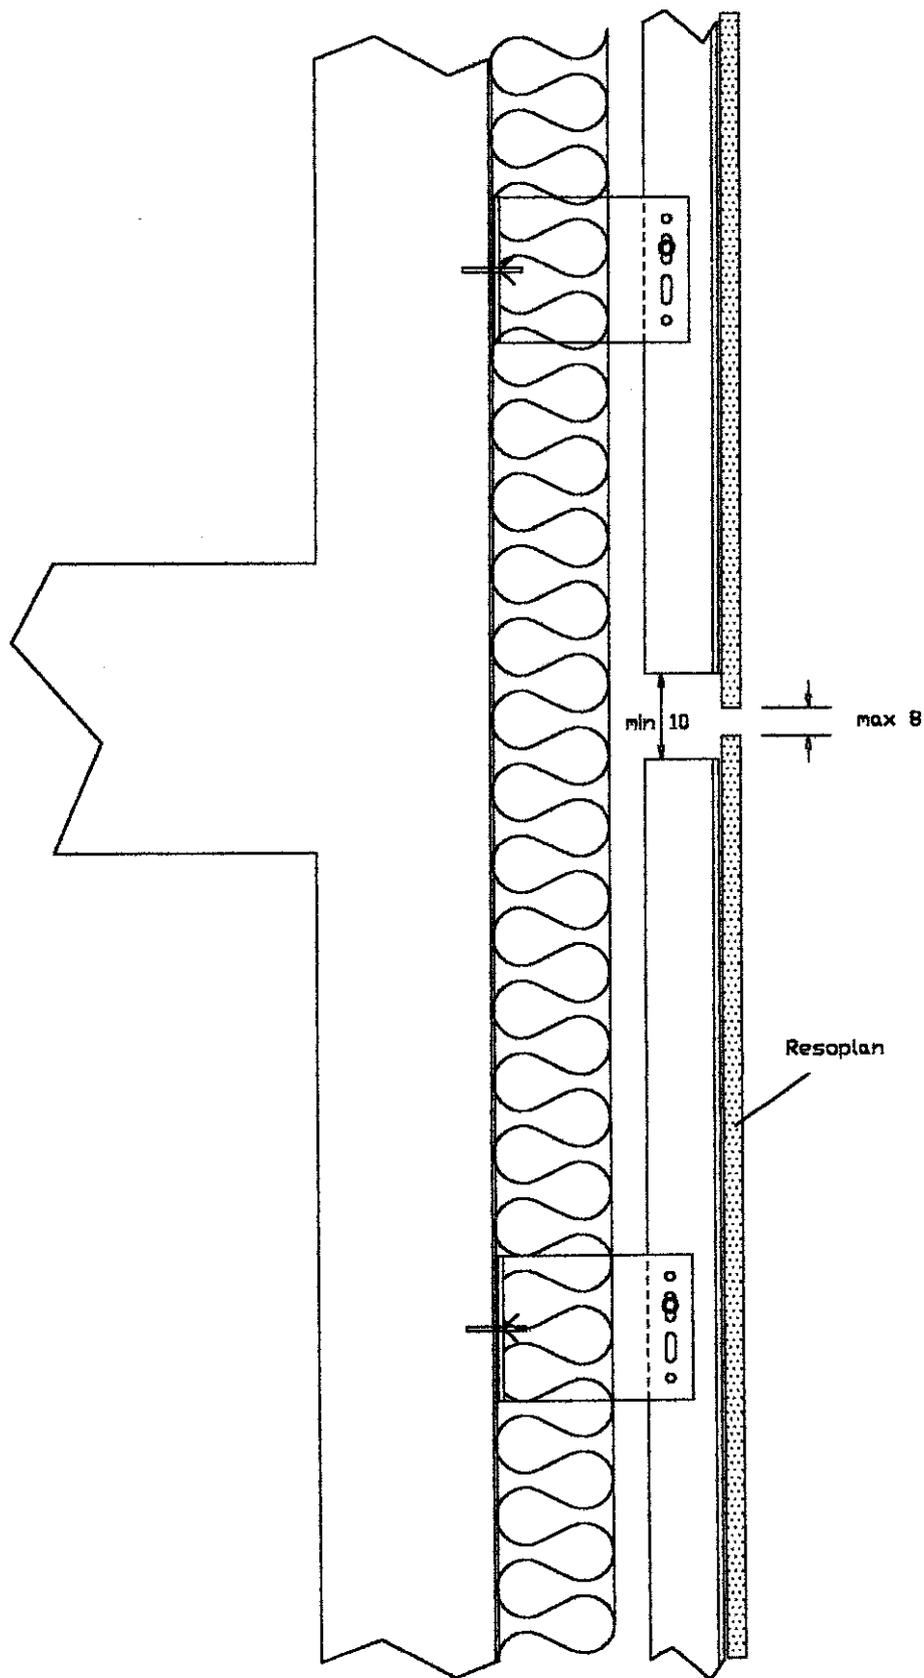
Pose en zones sismiques - Coupe verticale sur joint de fractionnement au droit de chaque plancher
